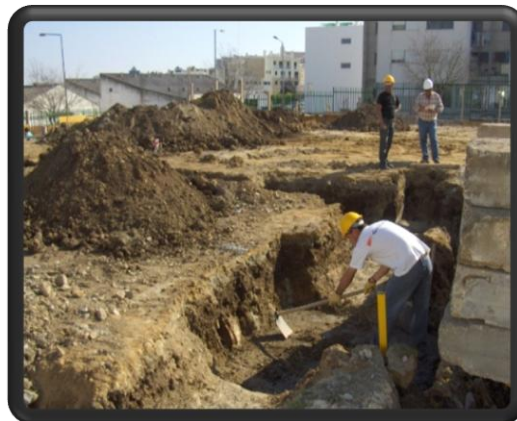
Vala aberta para sapatas e vigas de fundação
